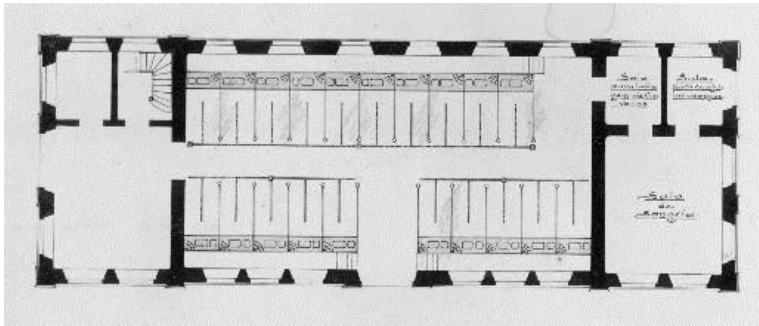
Planta original da Cavalaria (1905) - Fonte: acervo DAD/COC
